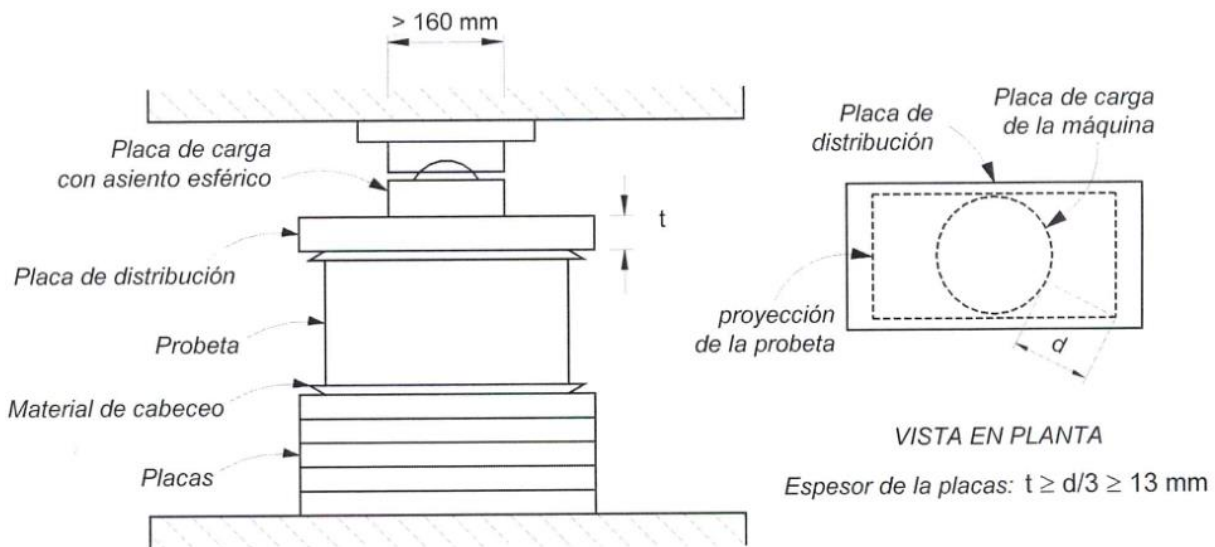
Ensayo de compresión mecánica simple, utilizando una máquina universal
